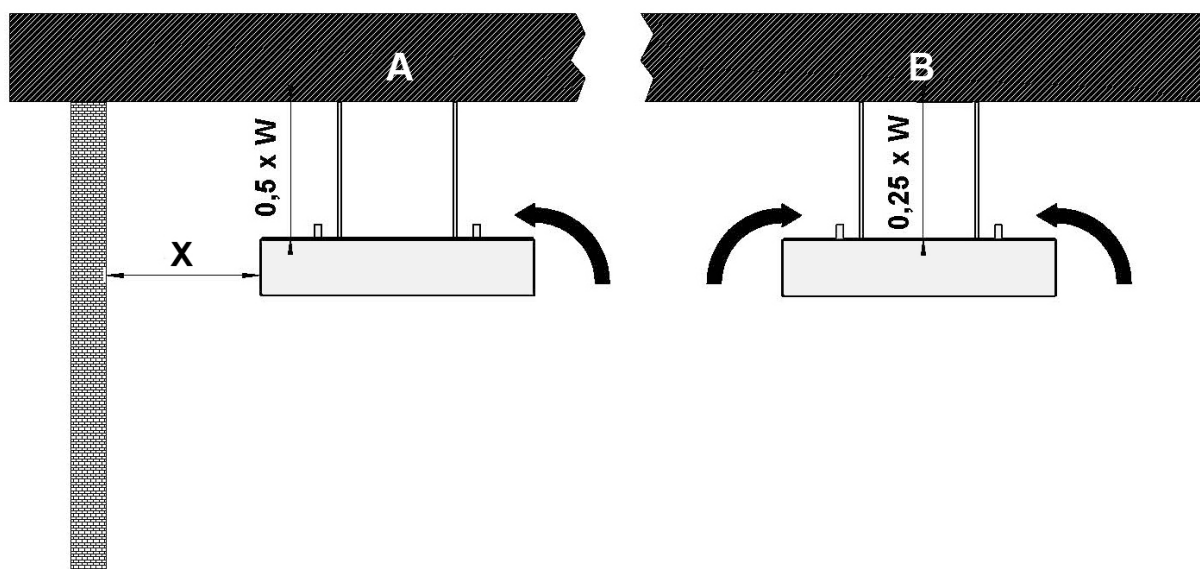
Halton Rex REP, distance d'installation par rapport au plafond
